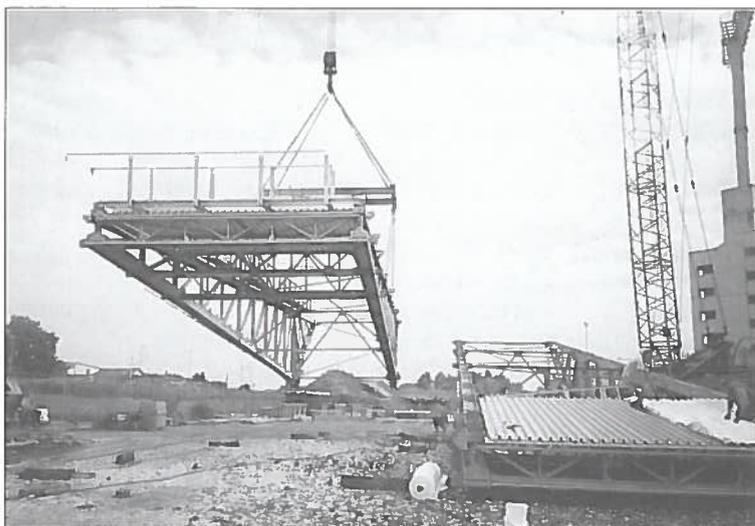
Fase di montaggio di un modulo della struttura di copertura.
